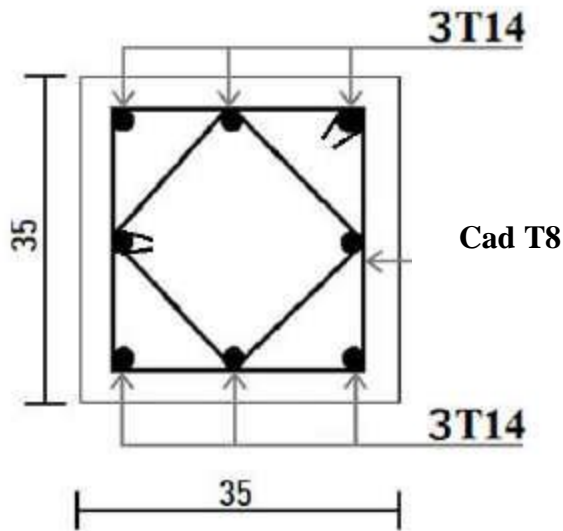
Ferrailage des poteaux (35x35) cm²
